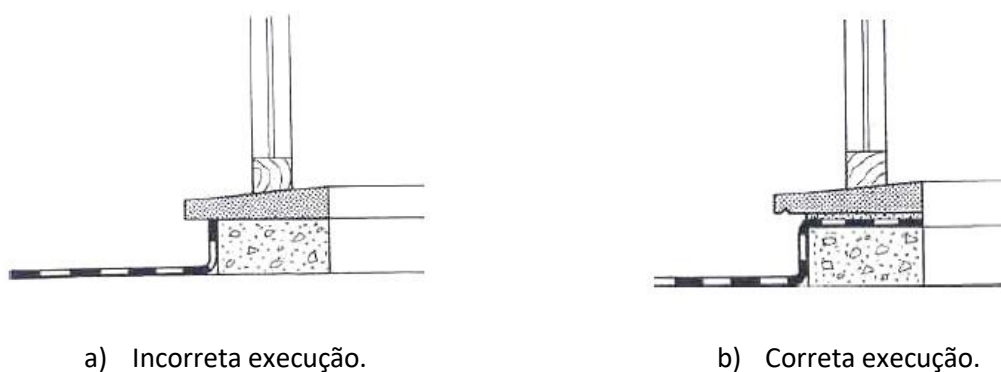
Exemplo de um remate com parede emergente sob soleira de portas mal executado e de um remate executado corretamente. (Lopes, 2002)
